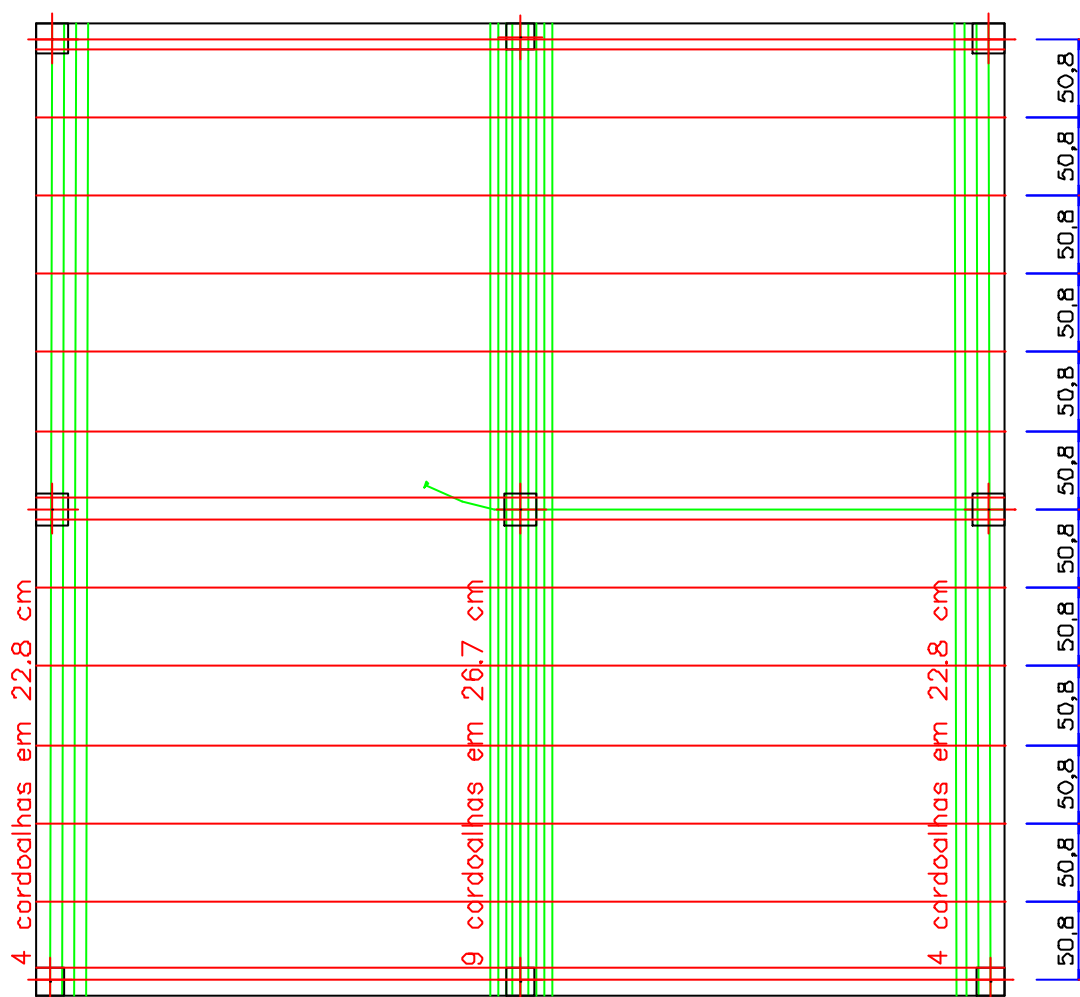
Arranjo dos Cabos da Laje III – 1976
